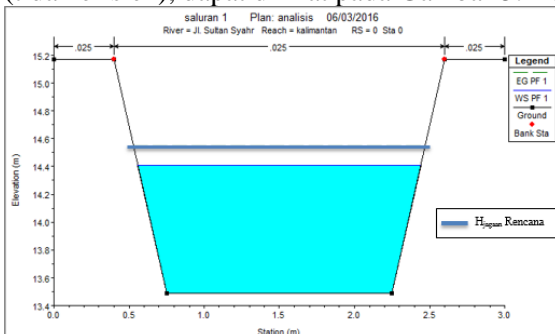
Cross Section profil saluran Sta.2 (J.2) pias I.
